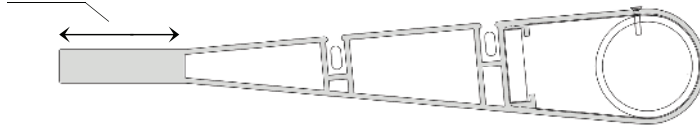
Glasfassade, Aluminiumquerschnitt des Sonnenschutzelementes
